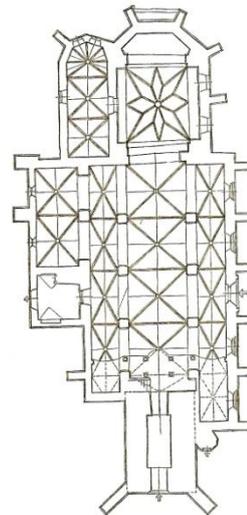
Spišská Nová Ves, Mariähimmelfahrtskirche, Grundriss, 2. H. 14. Jh.
